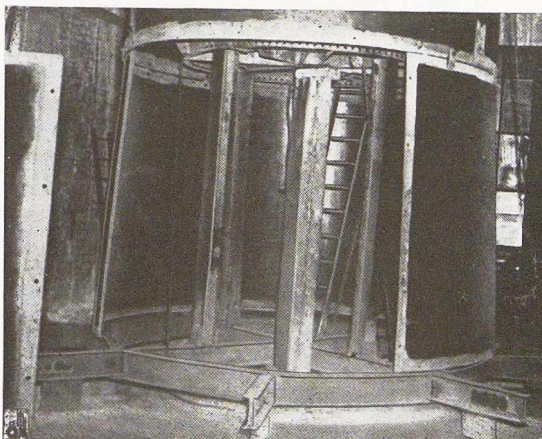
Plate-forme mobile employée pour le montage de la cheminée.
